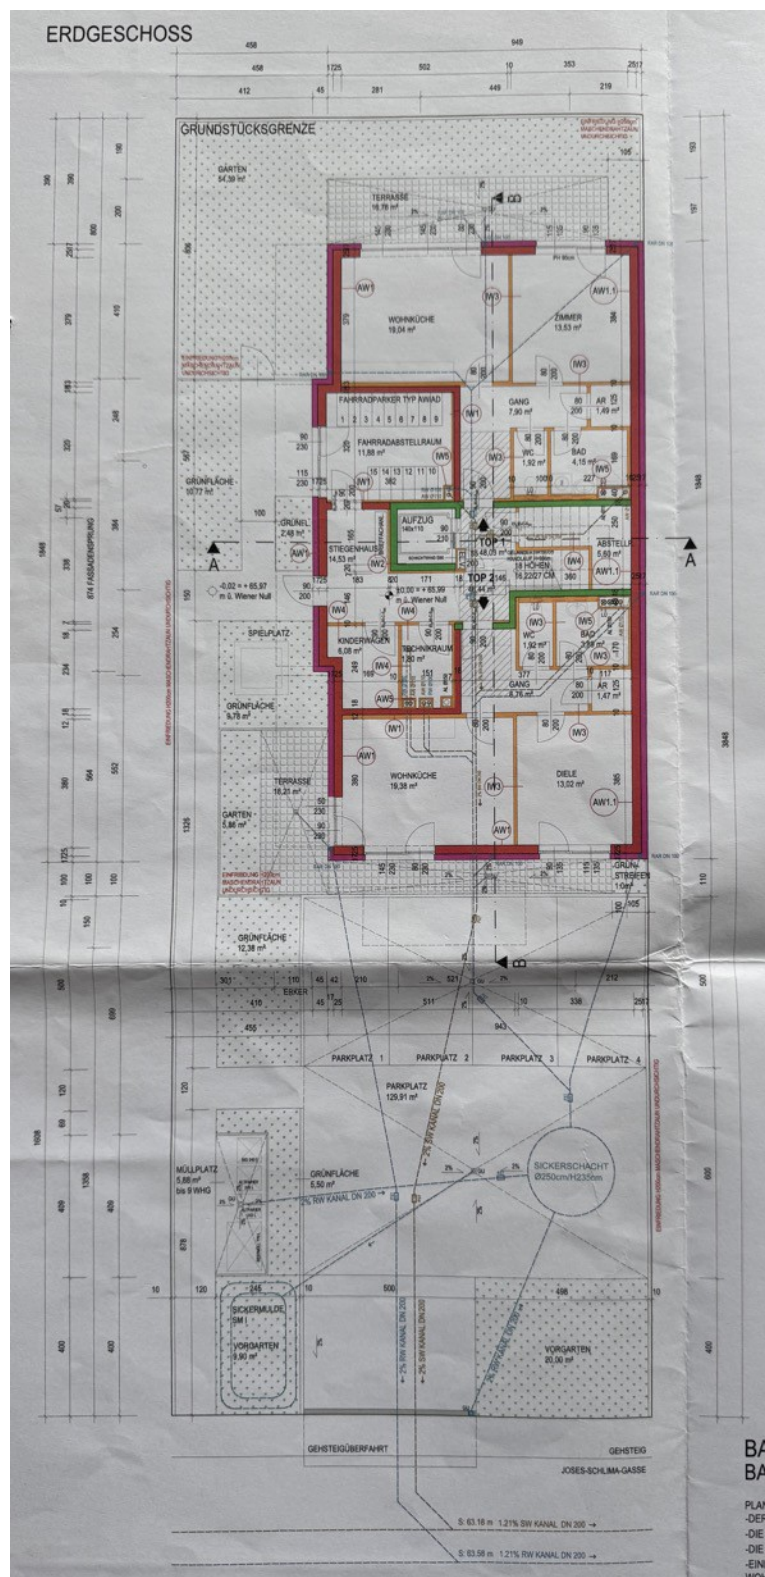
Einreichplan – Erdgeschoß / Quelle: auftraggebende Partei
